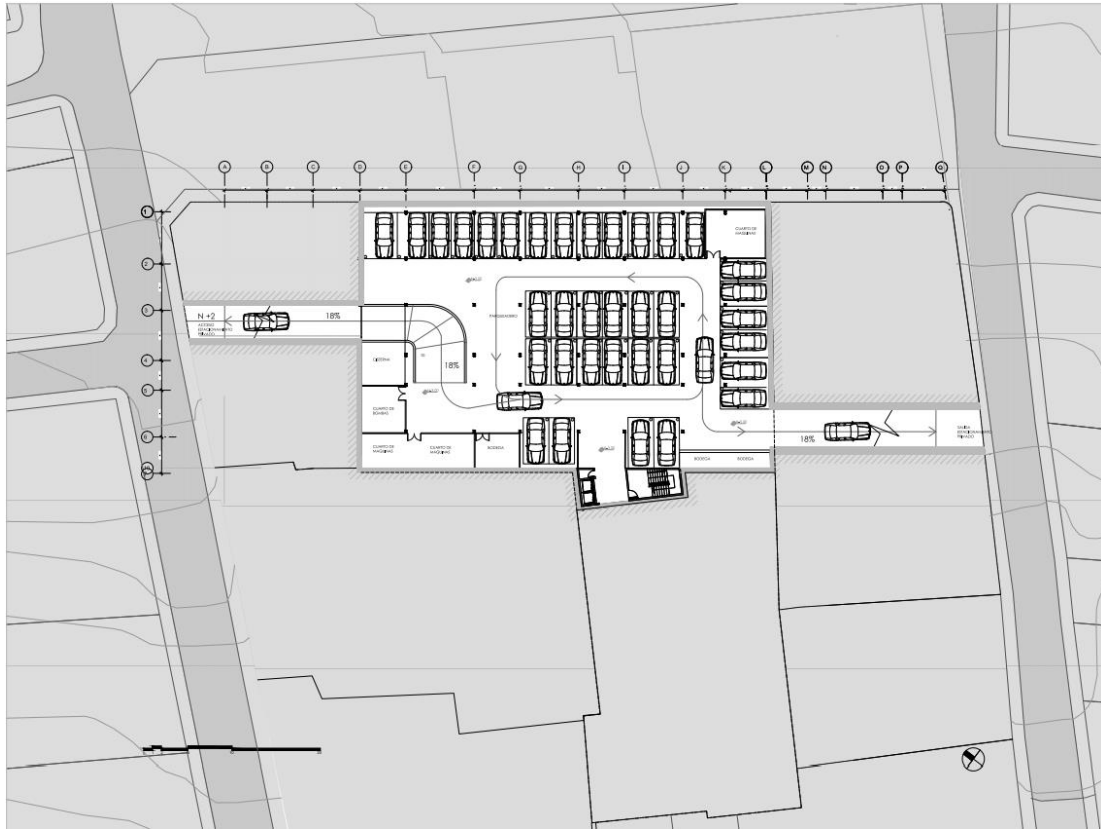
Planta de parqueaderos. Elaborado por Nacevilla 2020
